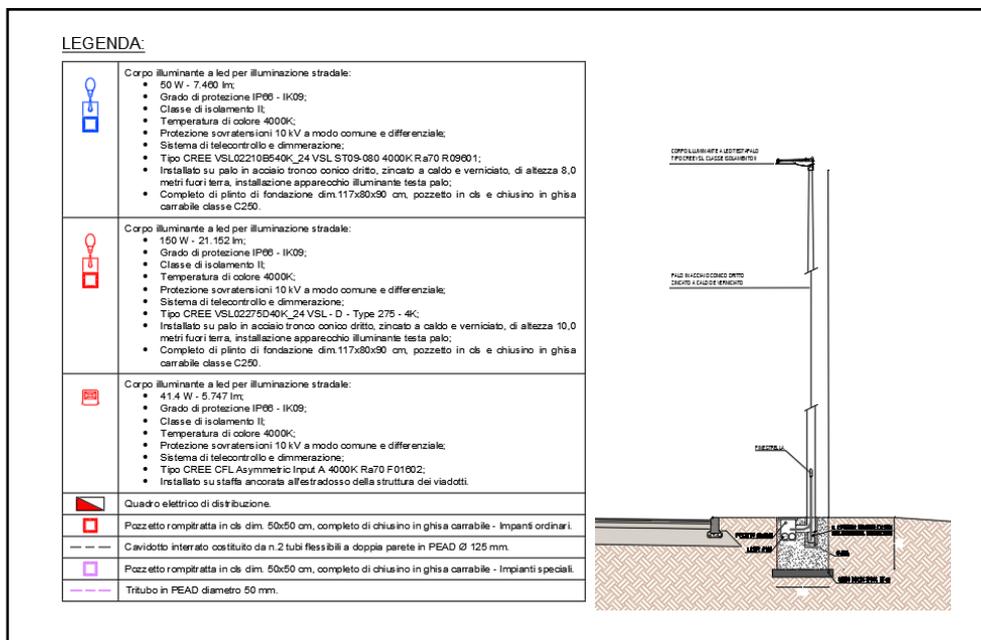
Legenda tecnica corpi illuminanti e schema geometrico
